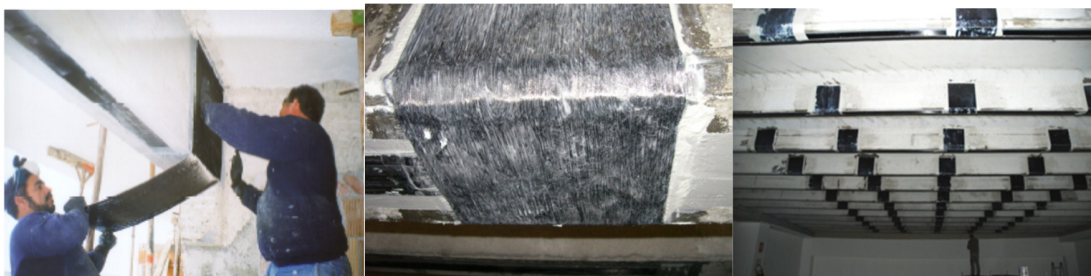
Uso de franjas FRP/SRP para anclaje del reforzamiento a flexión en vigas de hormigón armado.
